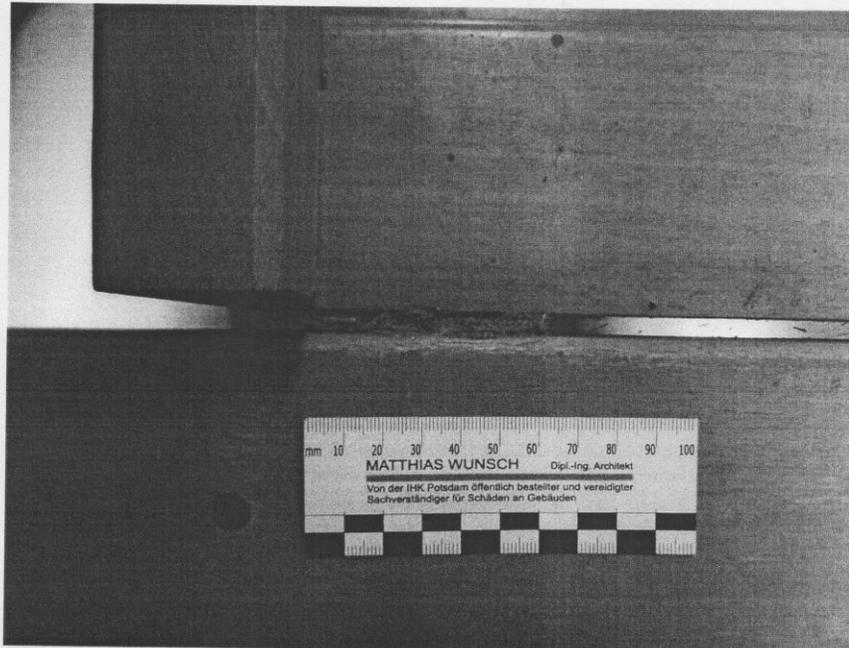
Detail aus Bild 29, Spalt zwischen Podest und Treppenlauf ist notdürftig ausgefüllt mit Holzwerkstoff
